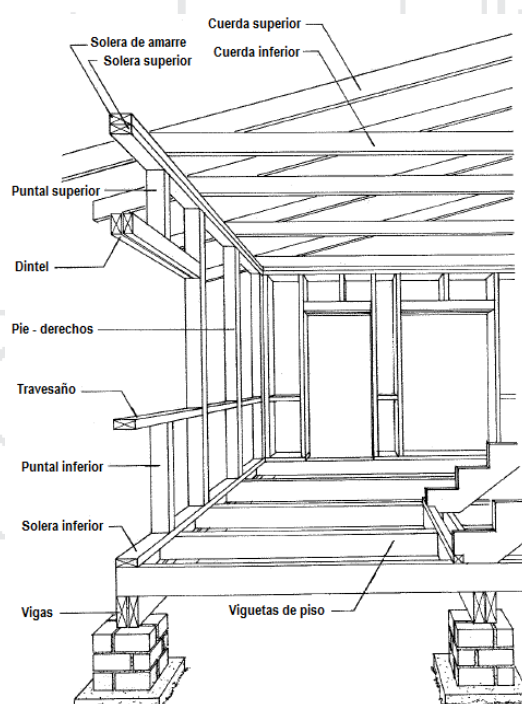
Madera de construcción estructural (JUNAC, PADT REFORT, 1984).
